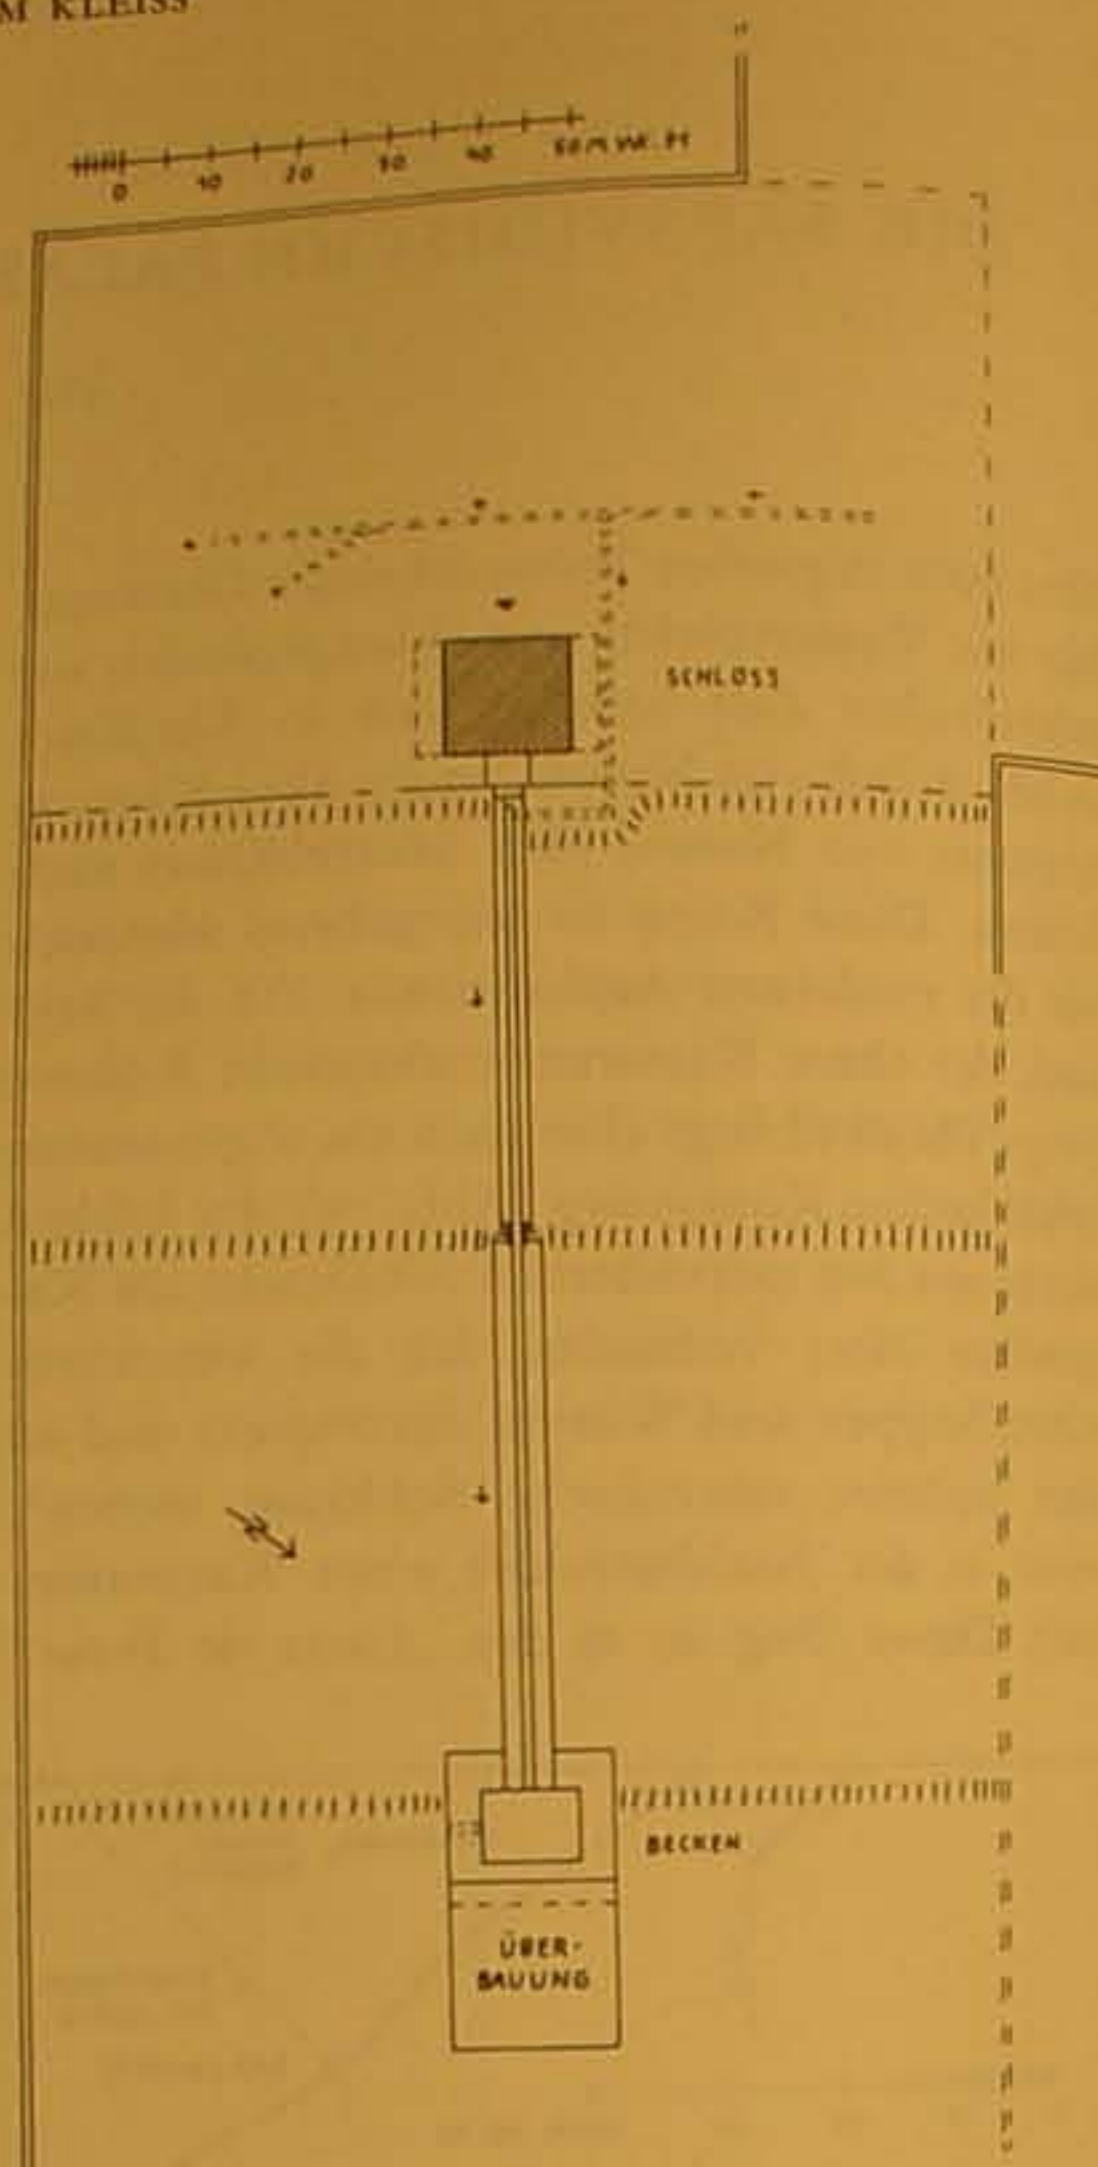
Tädjābād, Zentrale Gartenanlage, erhaltener Teil, Plan
